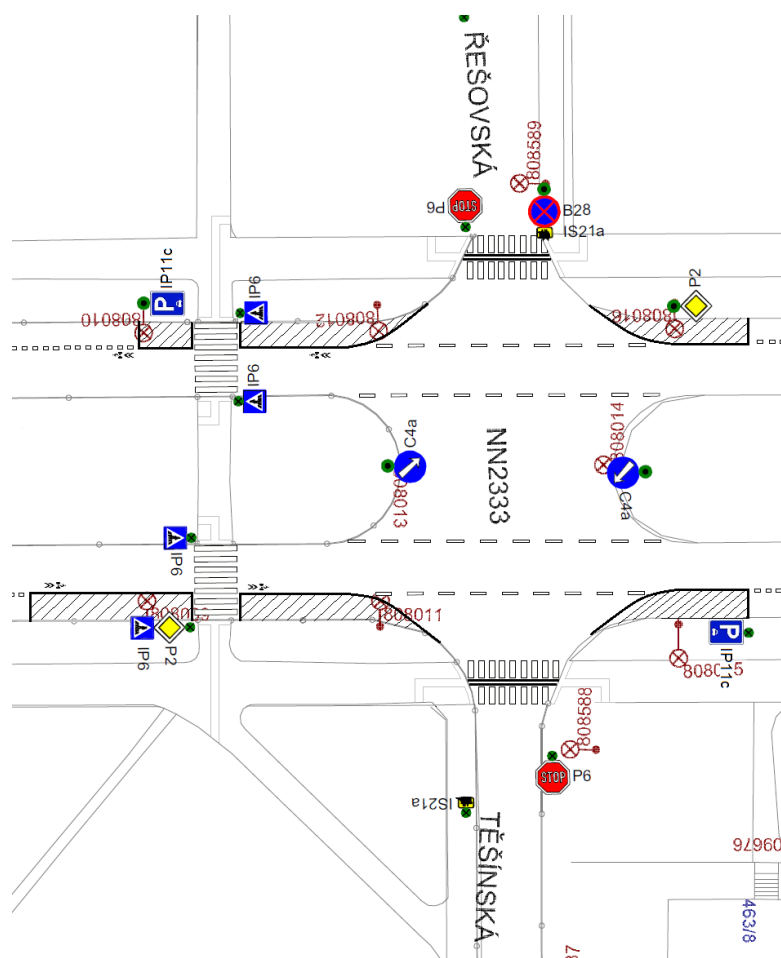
Úprava zákazu zastavení a vyhrazených stání
